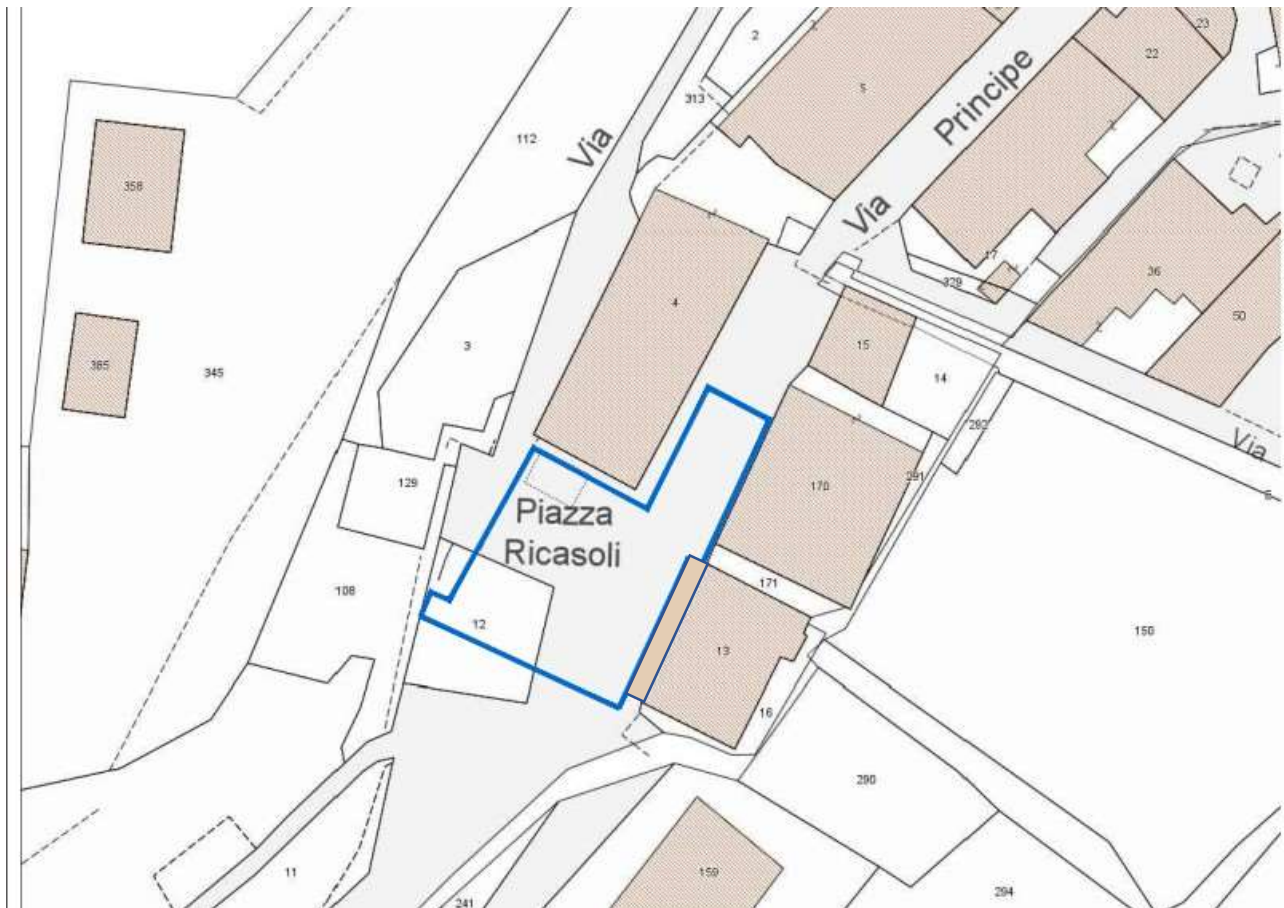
Stralcio di planimetria catastale con ubicazione dell'intervento
